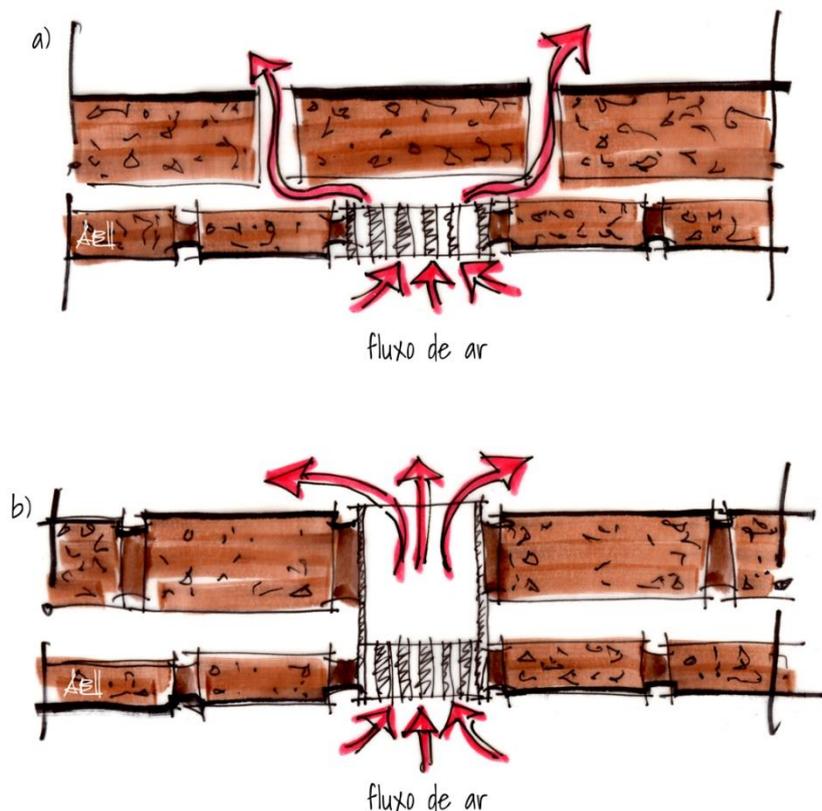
Escoamento do ar em paredes duplas através: (a) de fendas ou aberturas na alvenaria; (b) de troço de conduta
